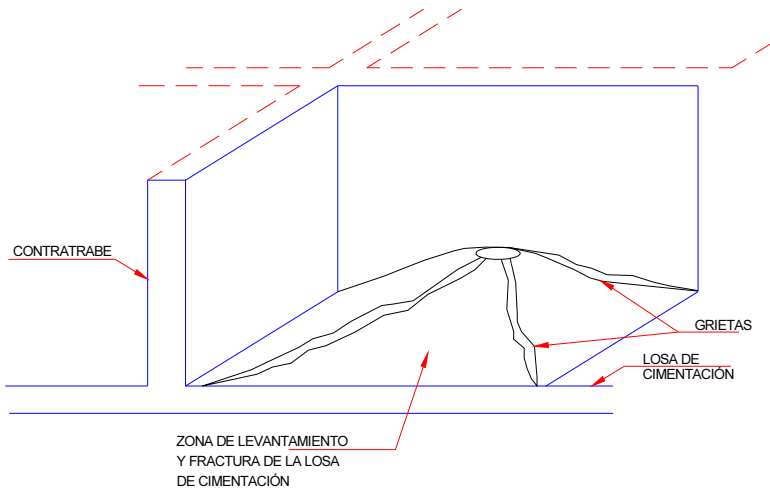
Celda que muestra los pilotes sin descabezar y la losa de cimentación fracturada.
